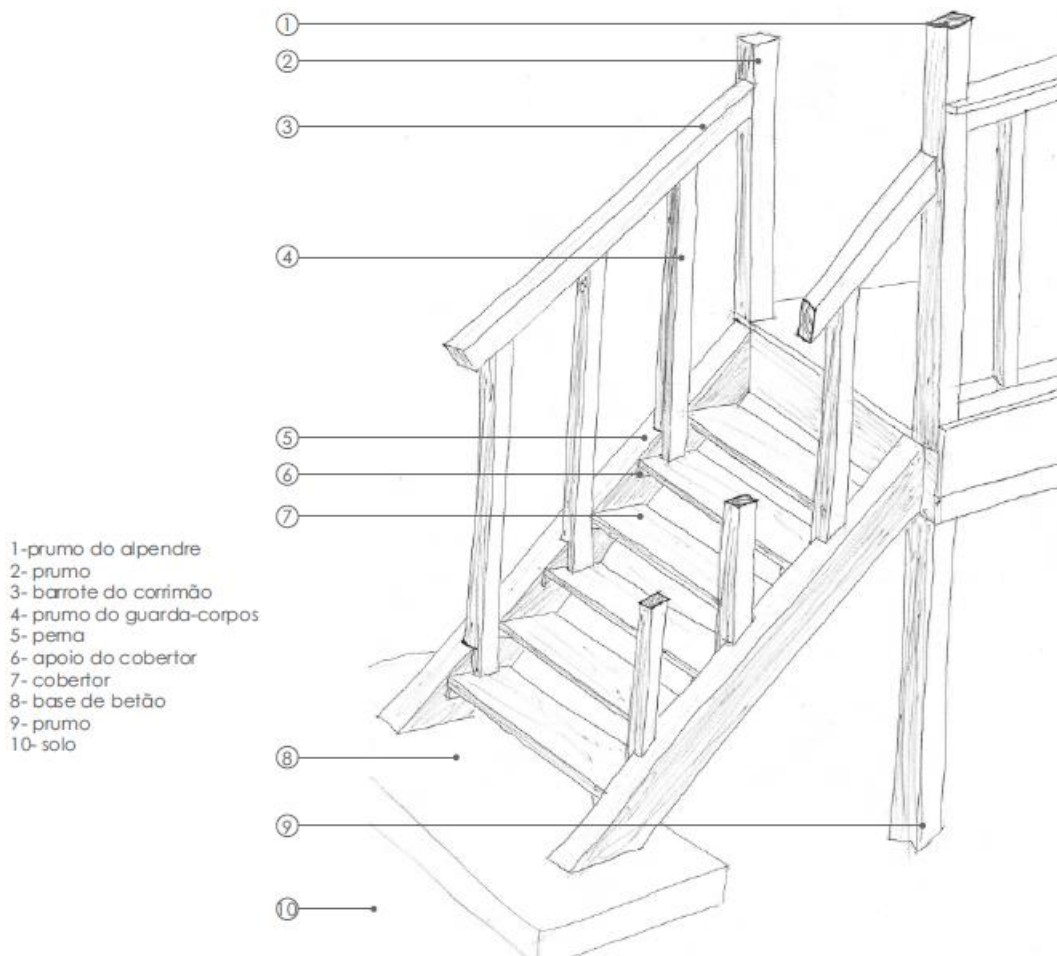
Pormenor tipo da escada exterior (fonte: Moutinho (2007))
